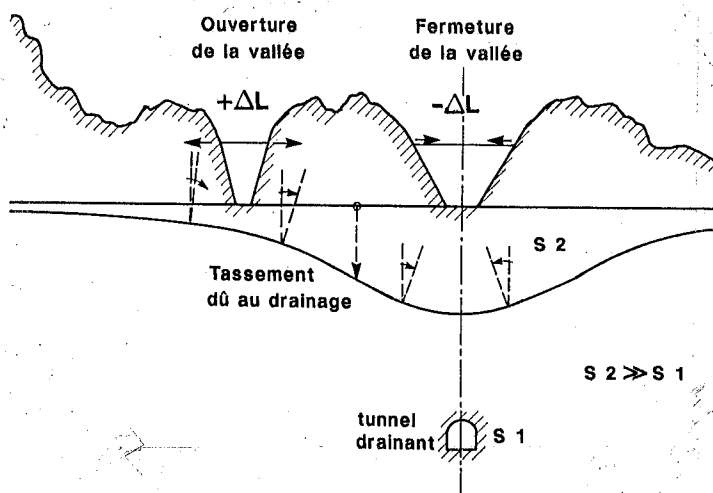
Ouverture ou fermeture de la vallée causées par le drainage dû à la construction d'un tunnel.
